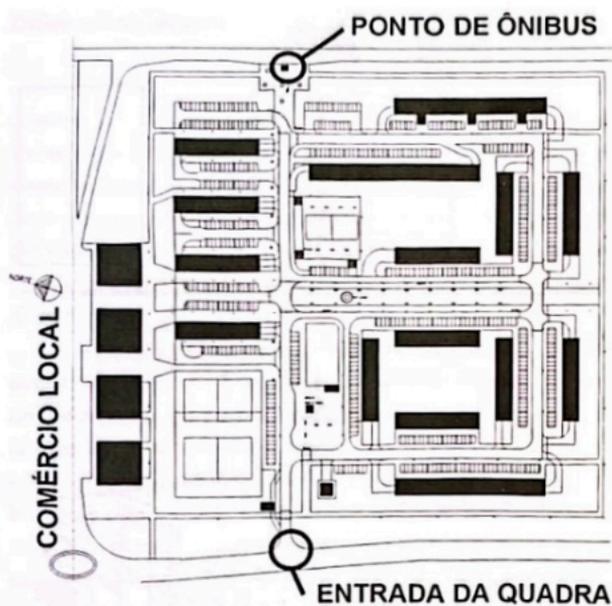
Planta baixa da SQN-109 (a posição dos blocos do comércio local foi dada).
